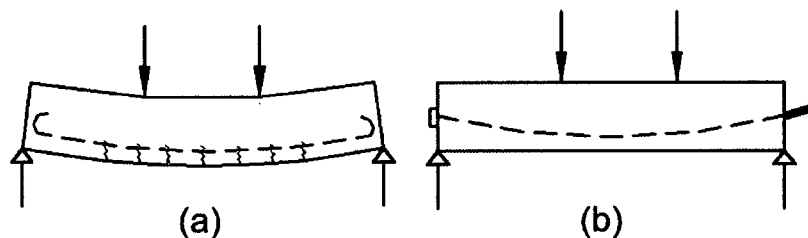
Deformación y agrietamiento en vigas de: a) Concreto reforzado y b) Concreto preesforzado.
